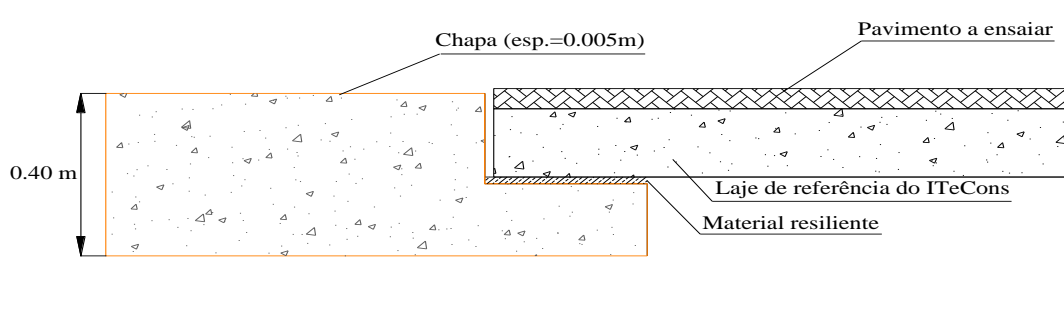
Pormenorização do apoio da laje de referência do ITeCons.
